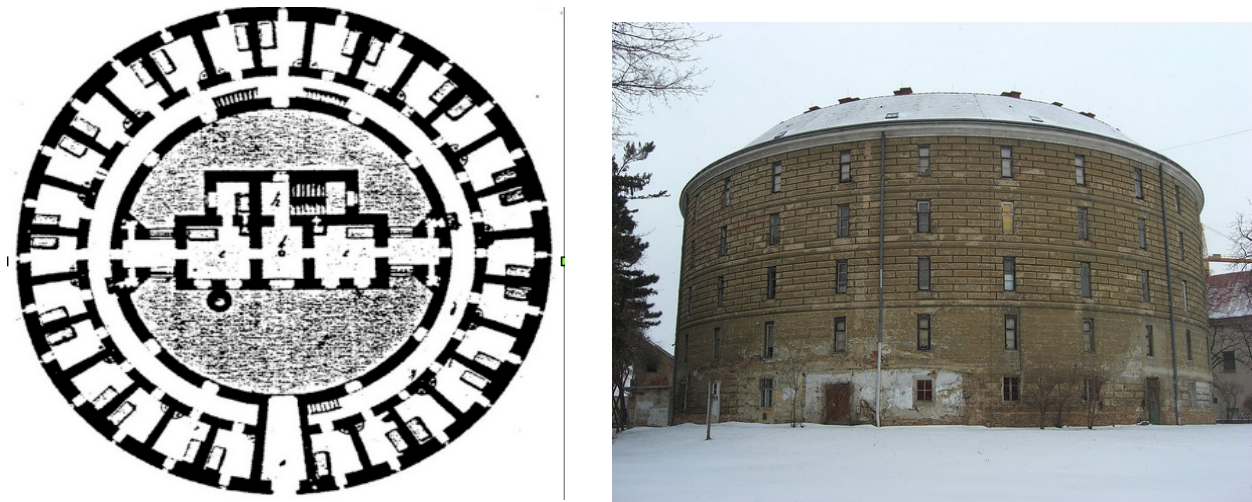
y 42: Plano de la planta del Narrenturm y aspecto exterior del edificio hoy en día.
